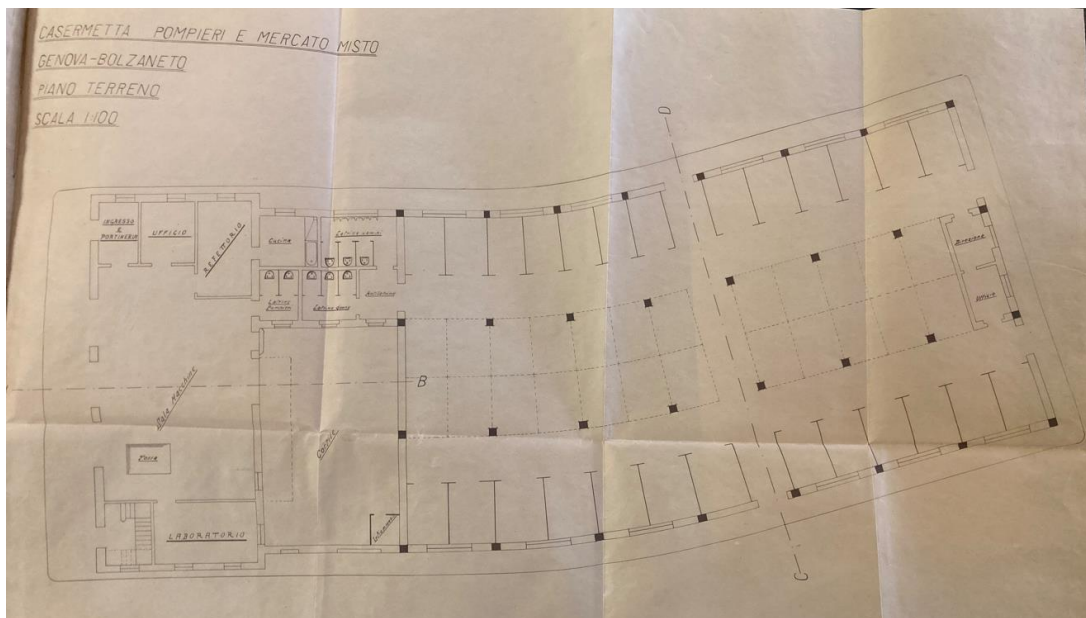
Planimetria generale dell'edificio da tavola del progetto storico presente in archivio (sezione Mercati)
